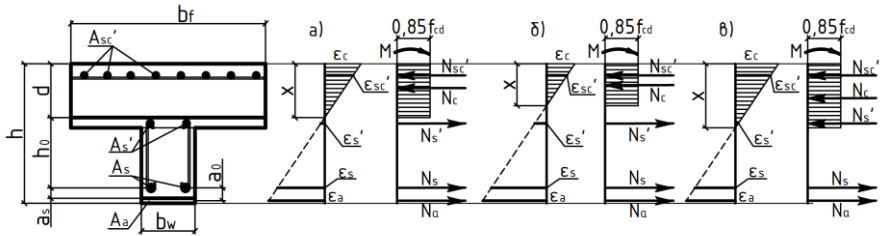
Випадки напружено-деформованого стану приведенного комбінованого таврового перерізу залізобетонного балкового елемента, що підсилюються шляхом нарощування перерізу додатковим залізобетонним шаром в стиснутій зоні та армуванням в розтягнутій зоні у вигляді шпренгельної затяжки чи додаткових поздовжніх арматурних стержнів
